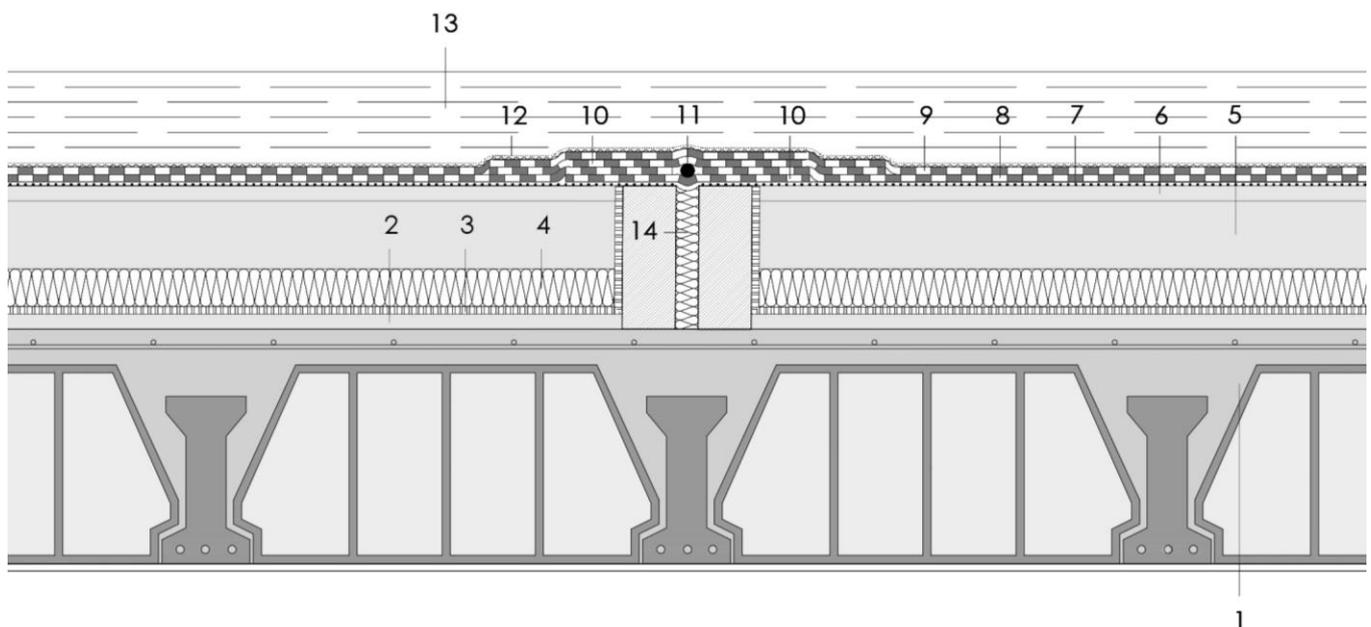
Detalle constructivo de junta de dilatación de la cubierta. E: 1/10
